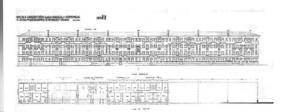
Vivienda colectiva del tipo B. Fachada principal al sur.
